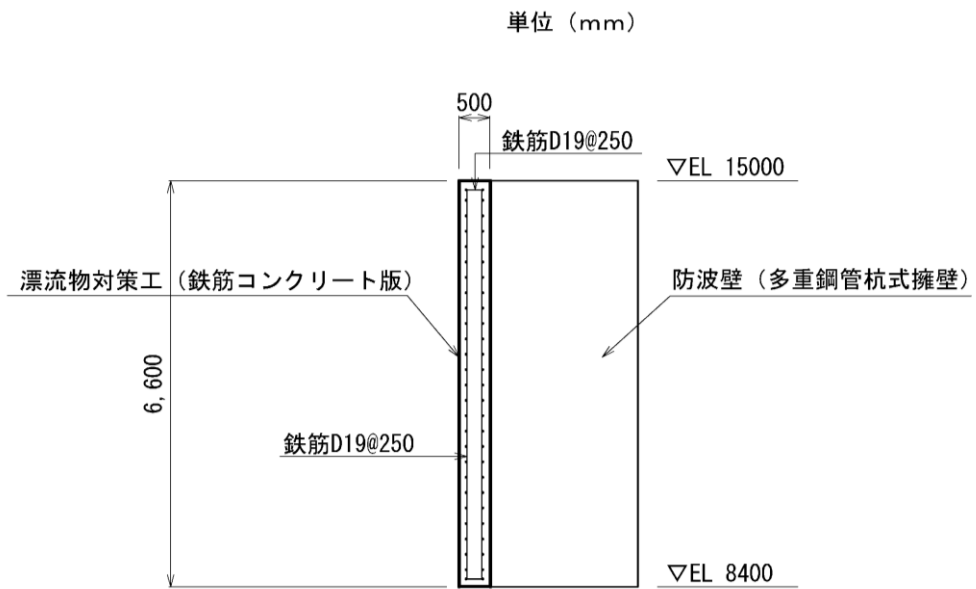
(2) 漂流物対策工 (鉄筋コンクリート版) の概略配筋図 (断面図)
